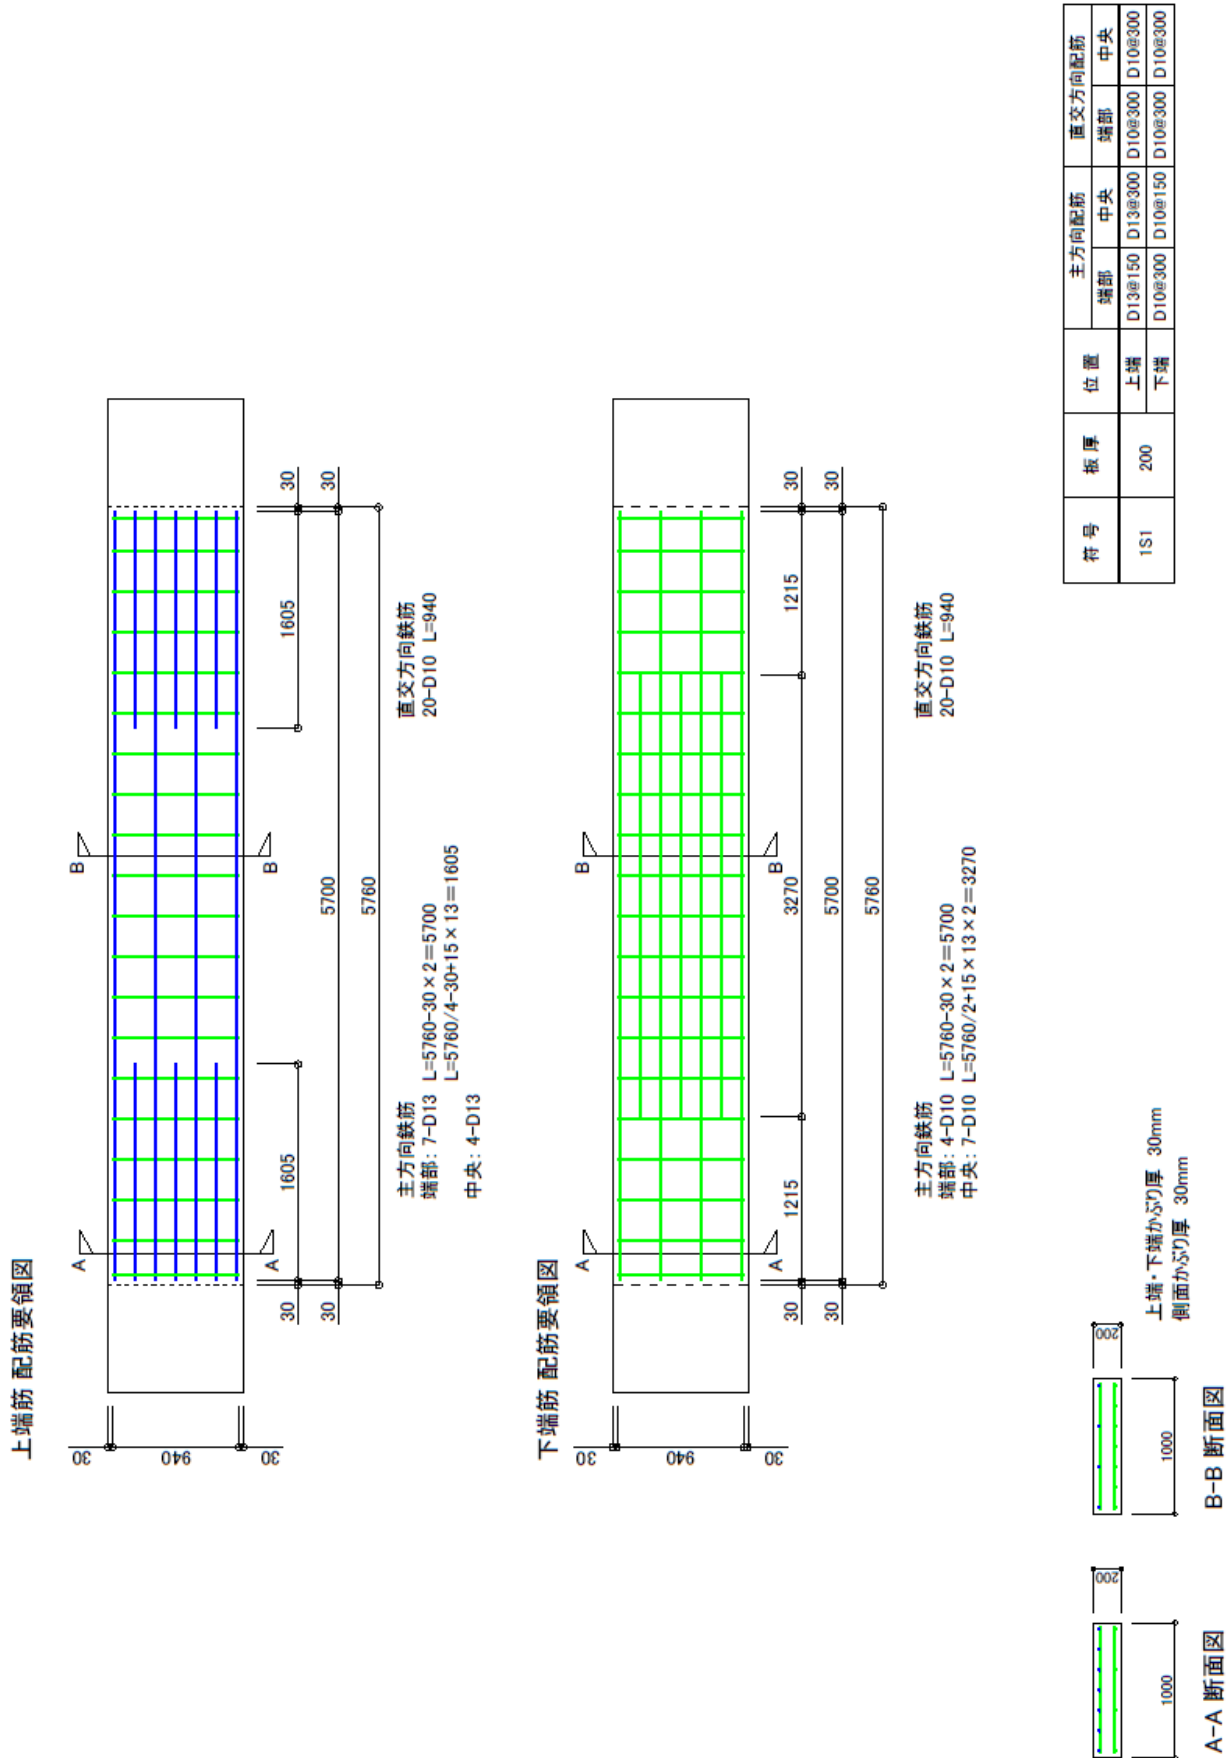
スラブ配筋図(AH, BA 試験体)
